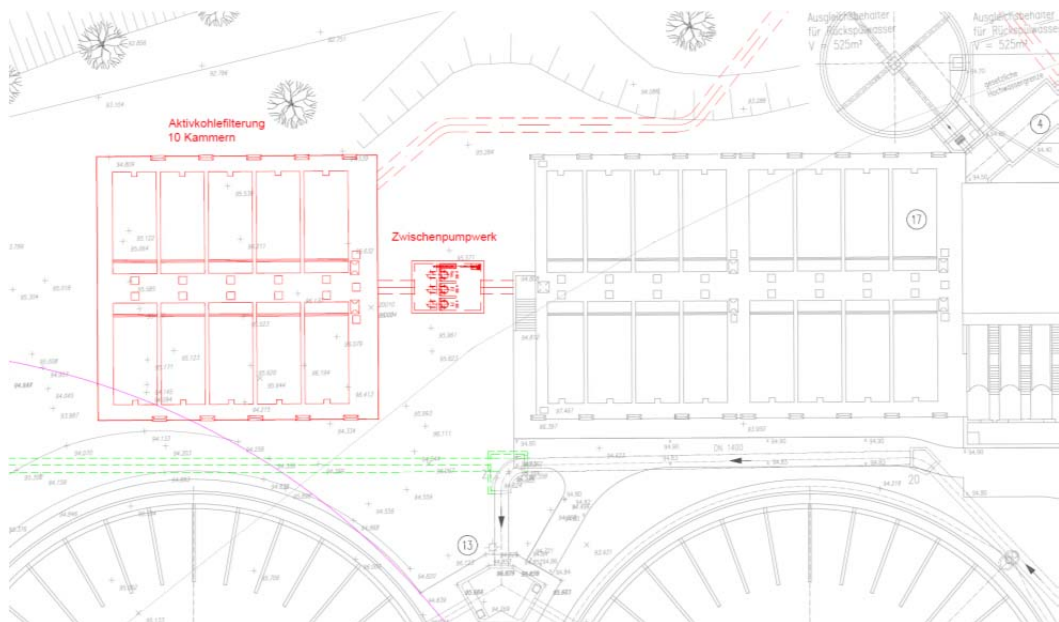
Lageplan Variante 2b: Neubau GAK-Filtration
